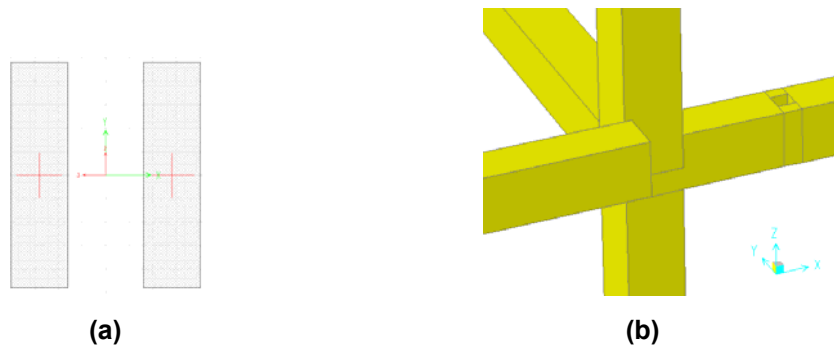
Ejemplo de la incorporación de una sección con una tubería embebida verticalmente (a) figura de la sección transversal creada en Section Designer y (b) figura en SAP-2000.
